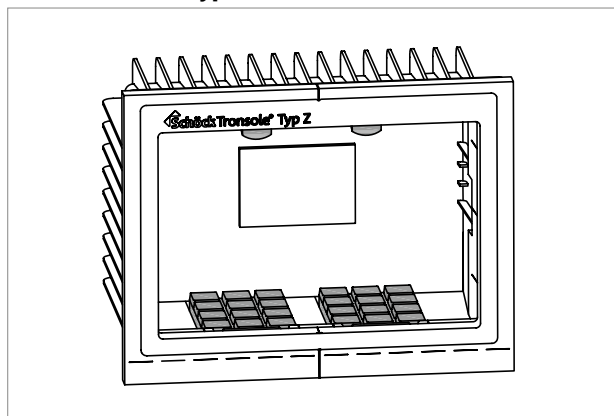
Schöck Tronsole® typ Z: Stěnové pouzdro se skládá z vnější plastové formy vyztužené žebry, vnitřního pouzdra, přípojného rámečku a integrovaných elastomerových ložisek Elodur®, která na obr. nejsou viditelná. Typový armokoš pro zabetonování v podestě lze k prvku přiobjednat.
